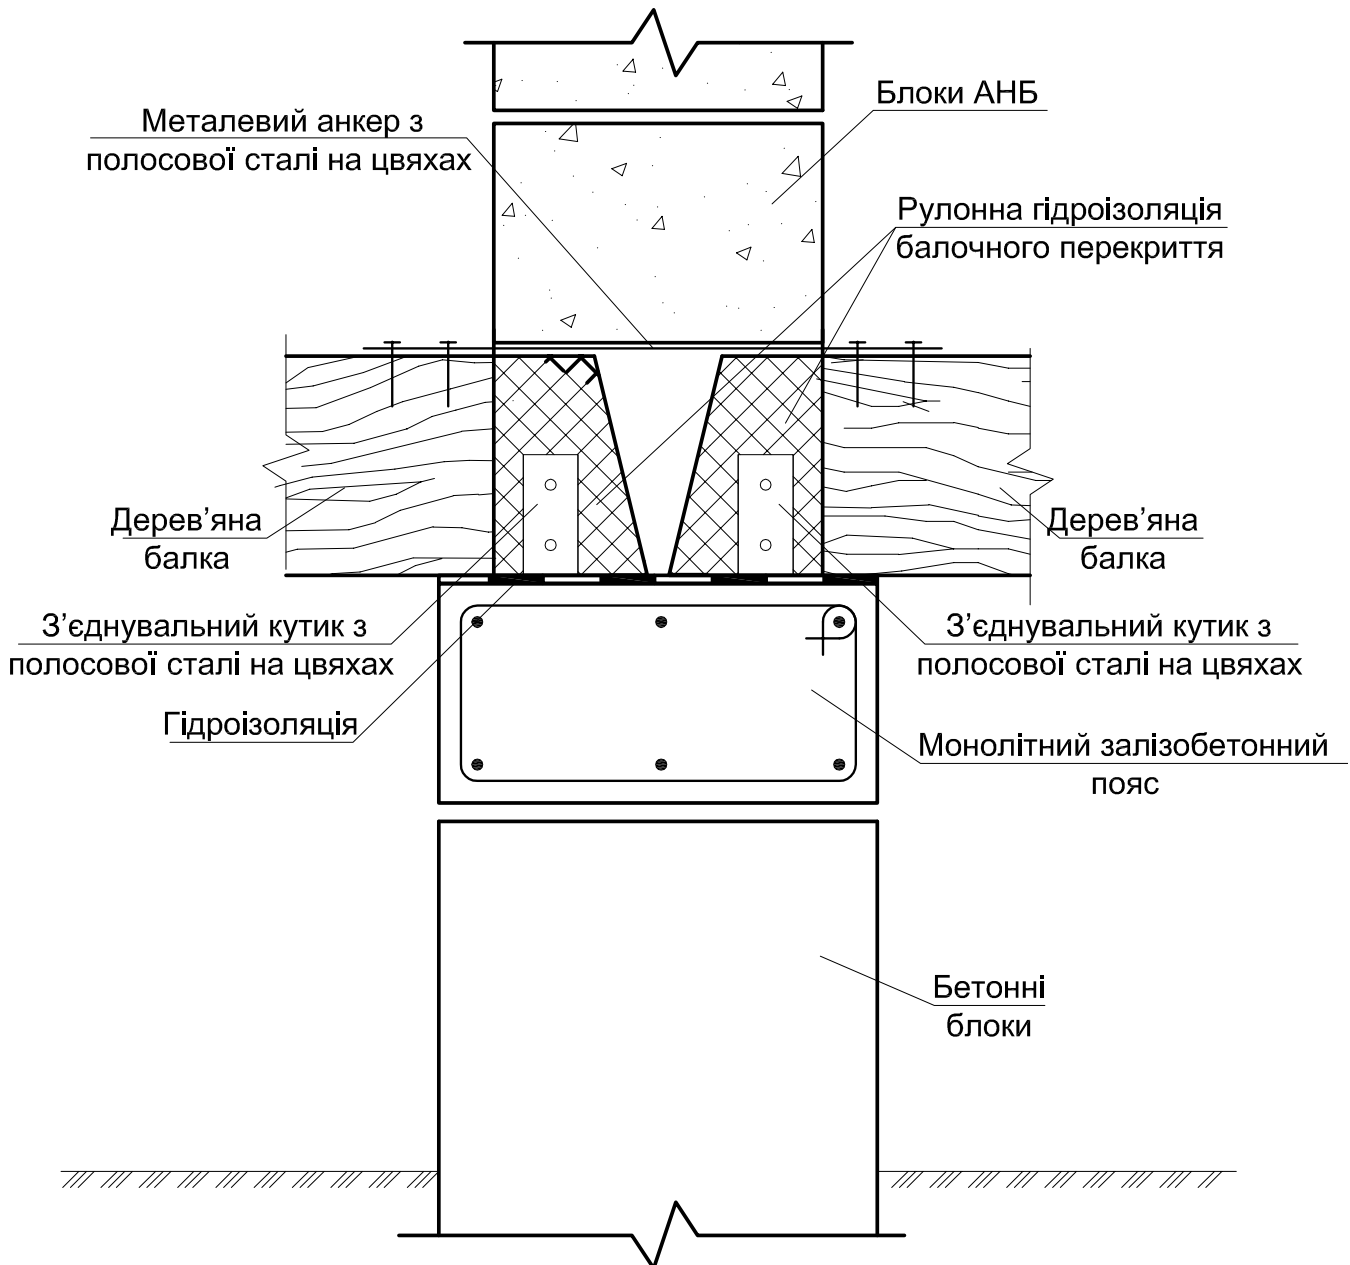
2-8. Спирання дерев'яного балочного перекриття на фундамент зовнішньої стіни
